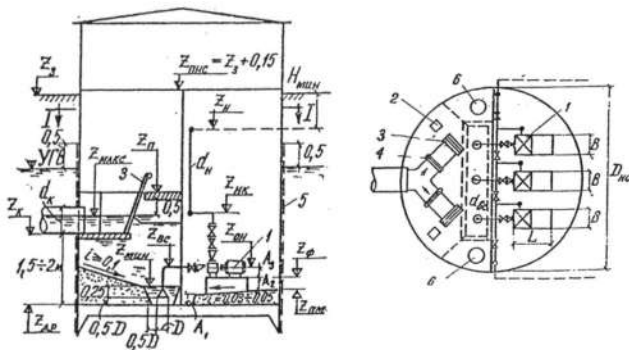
Расчетная схема ГКНС: 1 – насосный агрегат; 2 – дробилка; 3 – решетка; 4 – шибер; 5 – гидроизоляция; 6 – лаз в резервуар
